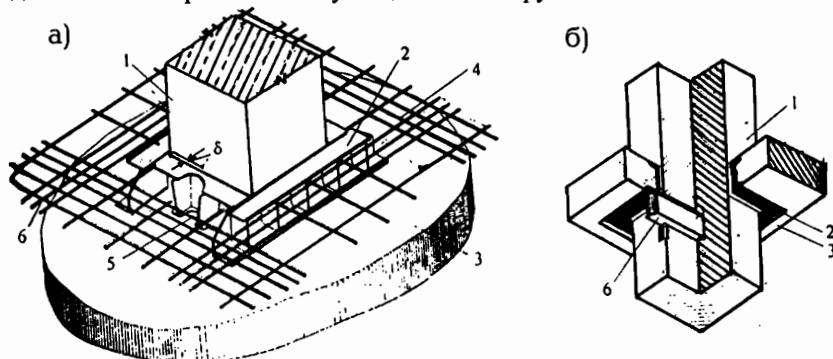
Конструкция соединения плиты перекрытия с колонной: а - конструктивная схема установки воротника в плите перекрытия; б - узел крепления плиты перекрытия с колонкой; 1 - колонна; 2 - воротник; 3 - плита перекрытия; 4 - арматура; 5 - гнездо для захвата тяги домкрата; 6 - закладной штырь
